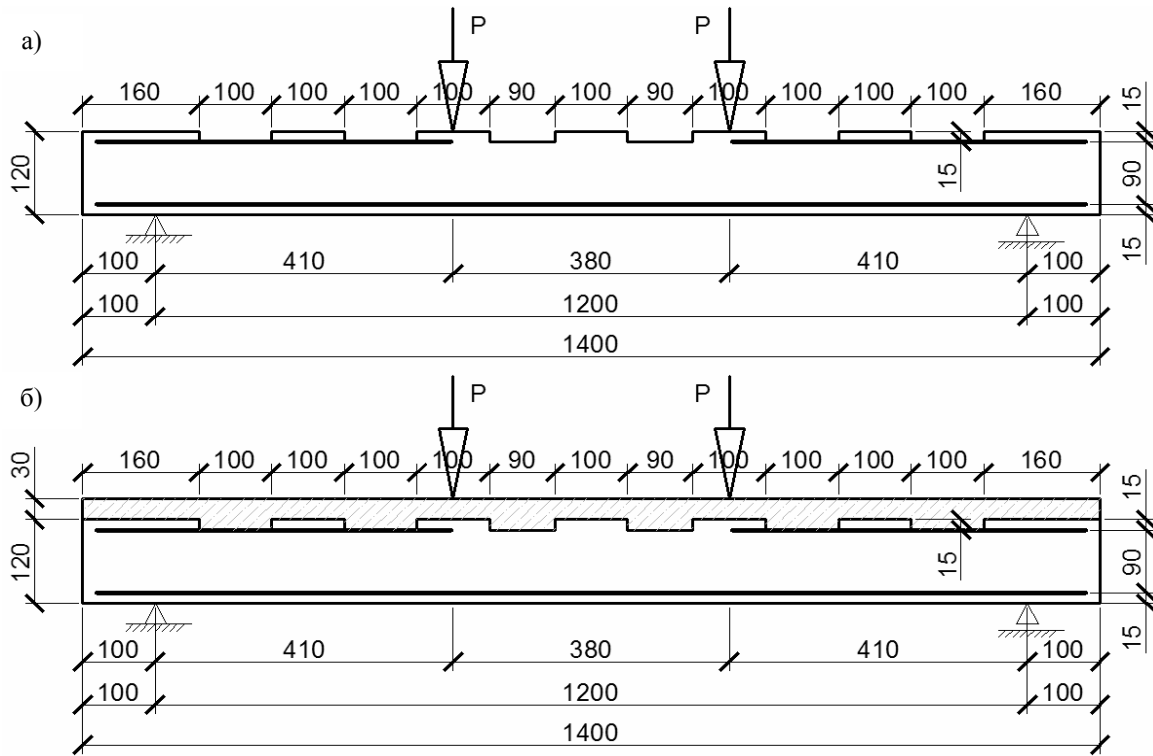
Схема нагружения опытной балки первой серии: а – базовой балки без усиления; б – балки, усиленной наращиванием сжатой зоны
